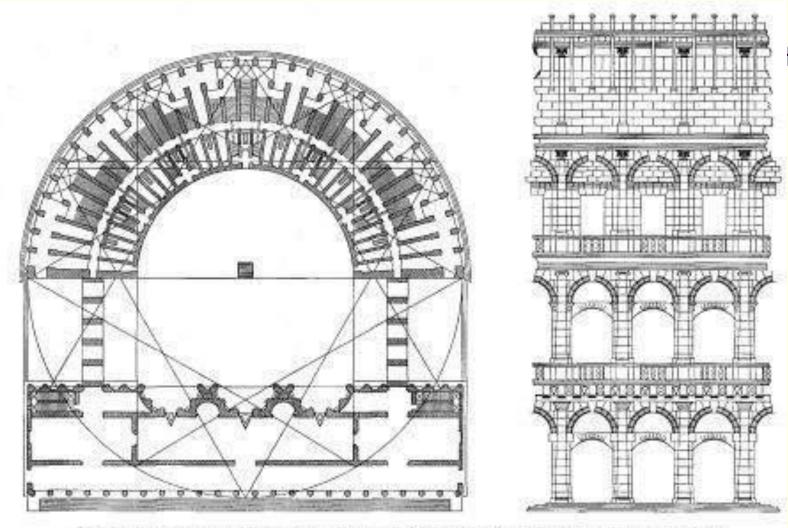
Элементы фасада и план римского Колизея на чертежах, выполненных в XV в.
